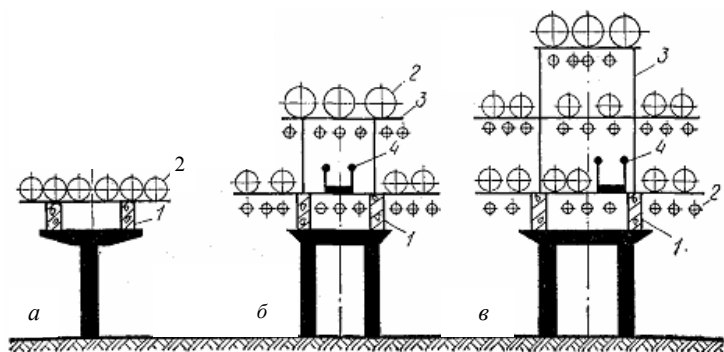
Сечения эстакад: а) одноярусное; б) двухярусное; в) трехярусное; 1 – продольные балки; 2 – трубопроводы; 3 – надстройка; 4 – настил для прохода
